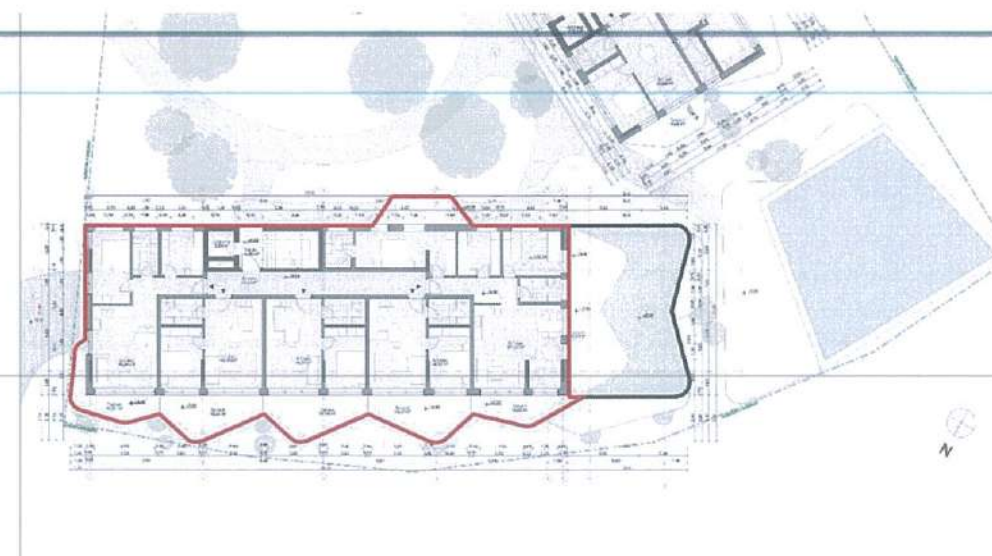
Planimetria e katit të tretë – Sip. kati të treteë 481.4m²
